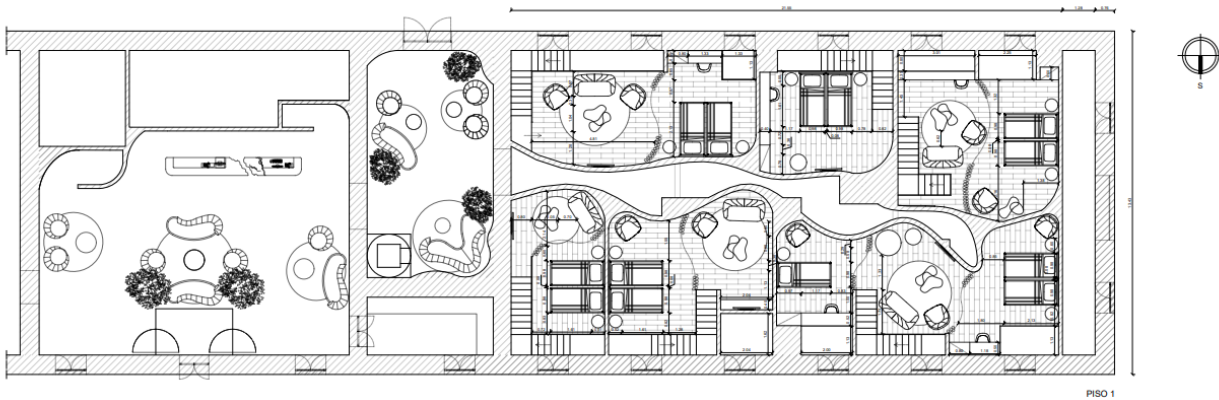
Planta de Equipamento Cotada, Piso 1, Alojamento Olive
